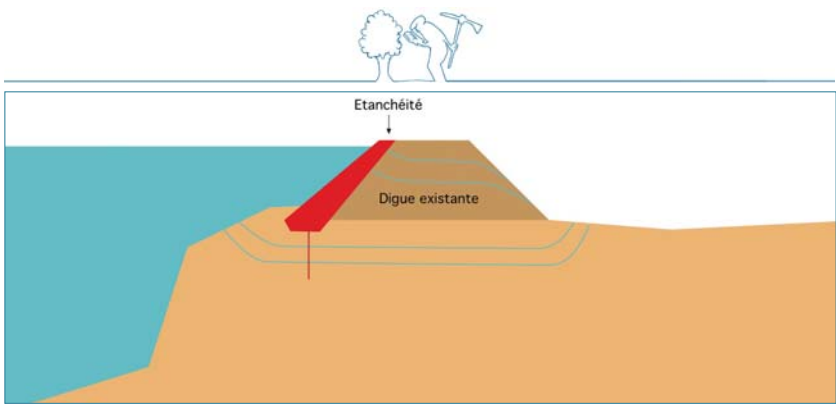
Coupe de principe d'une recharge étanche ancrée sur rideau d'étanchéité en fondation (figure R. Tourment, Irstea).
